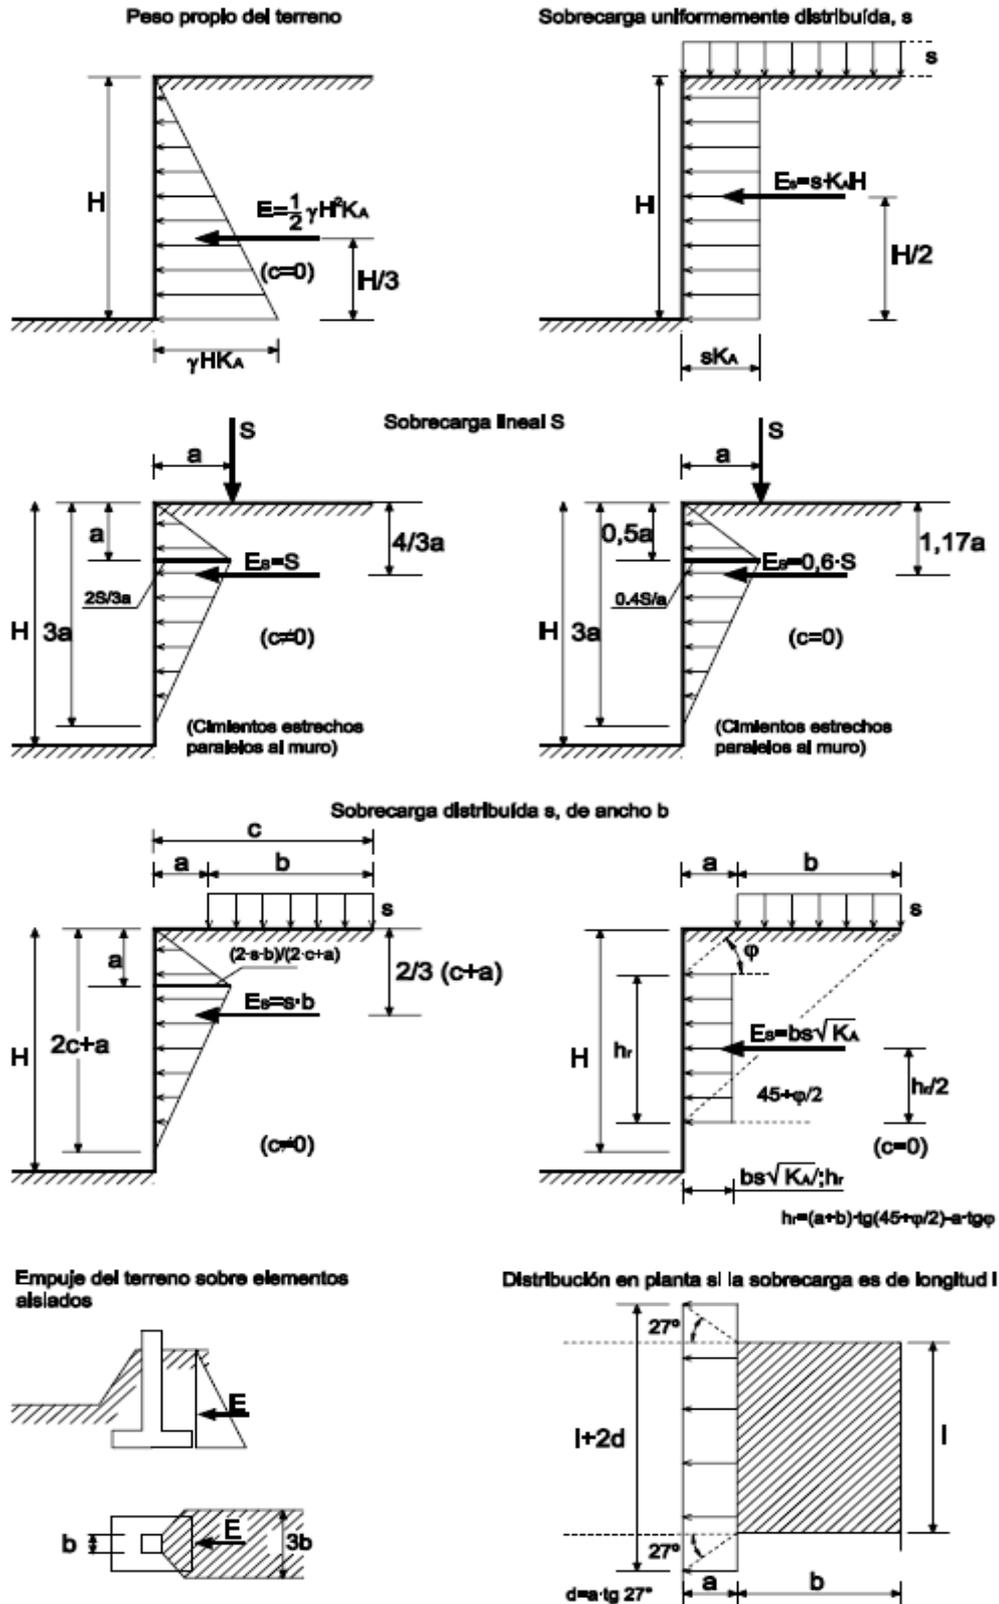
Criterios Simplificados para Diagramas de Empuje Debidos a Sobrecargas
